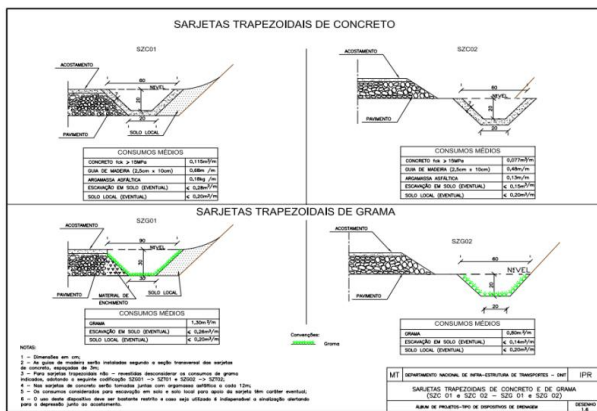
Sarjetas trapezoidal de concreto Fonte: DNIT (2018).
